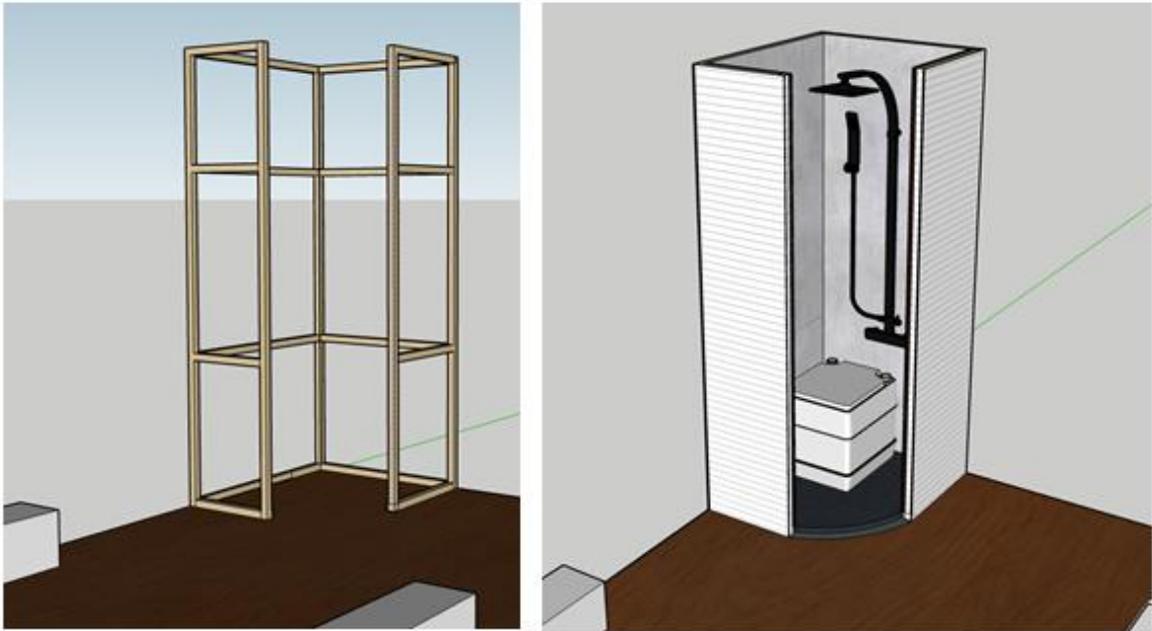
Estructura y diseño del baño. Fuente: Elaboración propia
